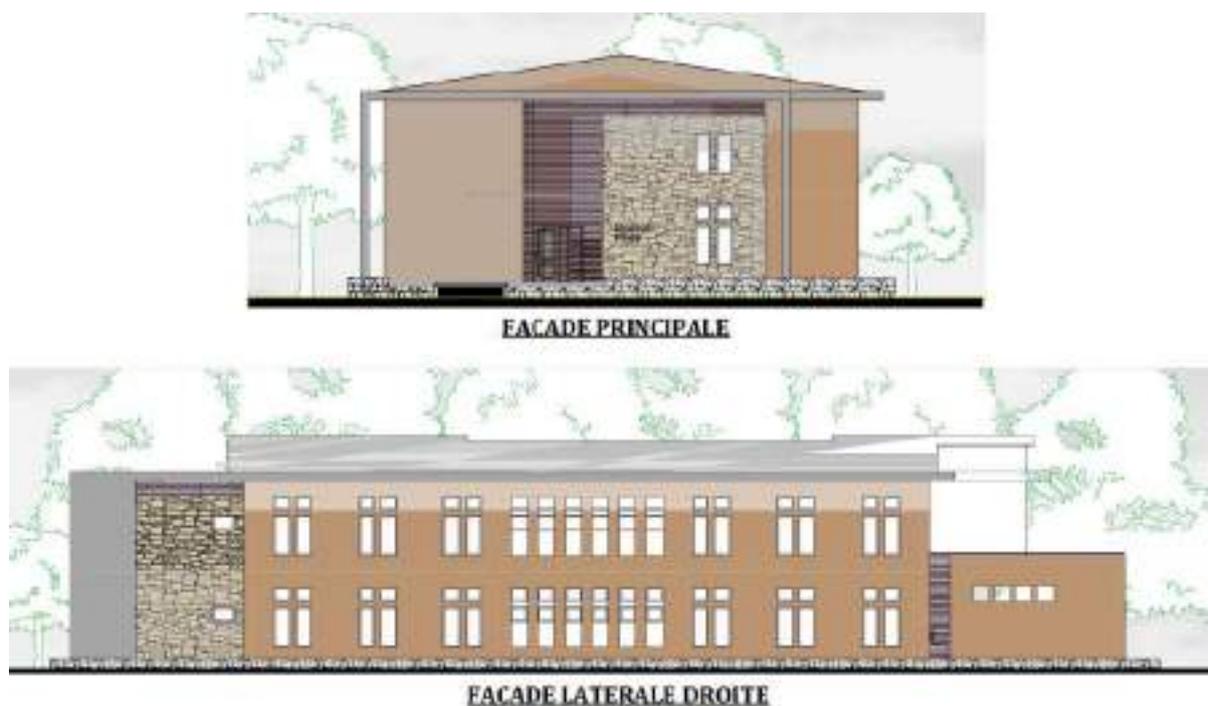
Façade principale et façade latérale des dortoir fille/garçons
